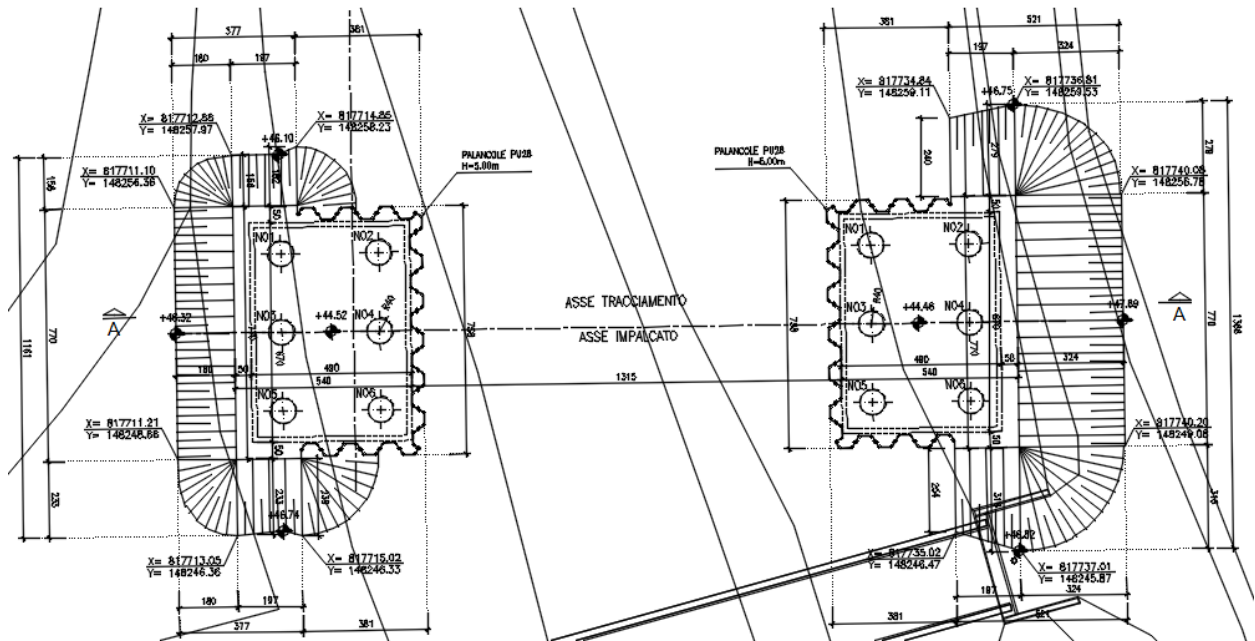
Pianta delle spalle con indicazione delle palancole provvisionali
